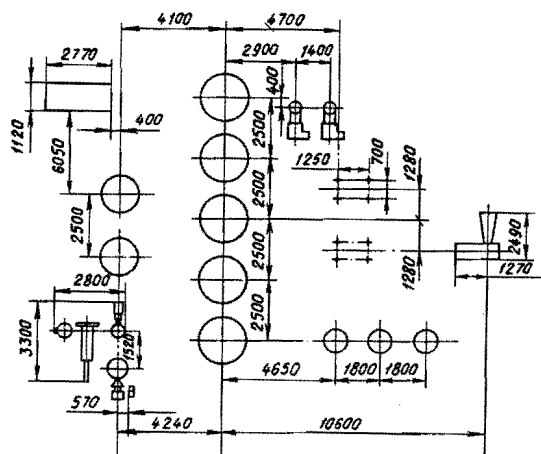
План размещения оборудования и отверстий под фундаментные болты линии марки А1-ОЛО
